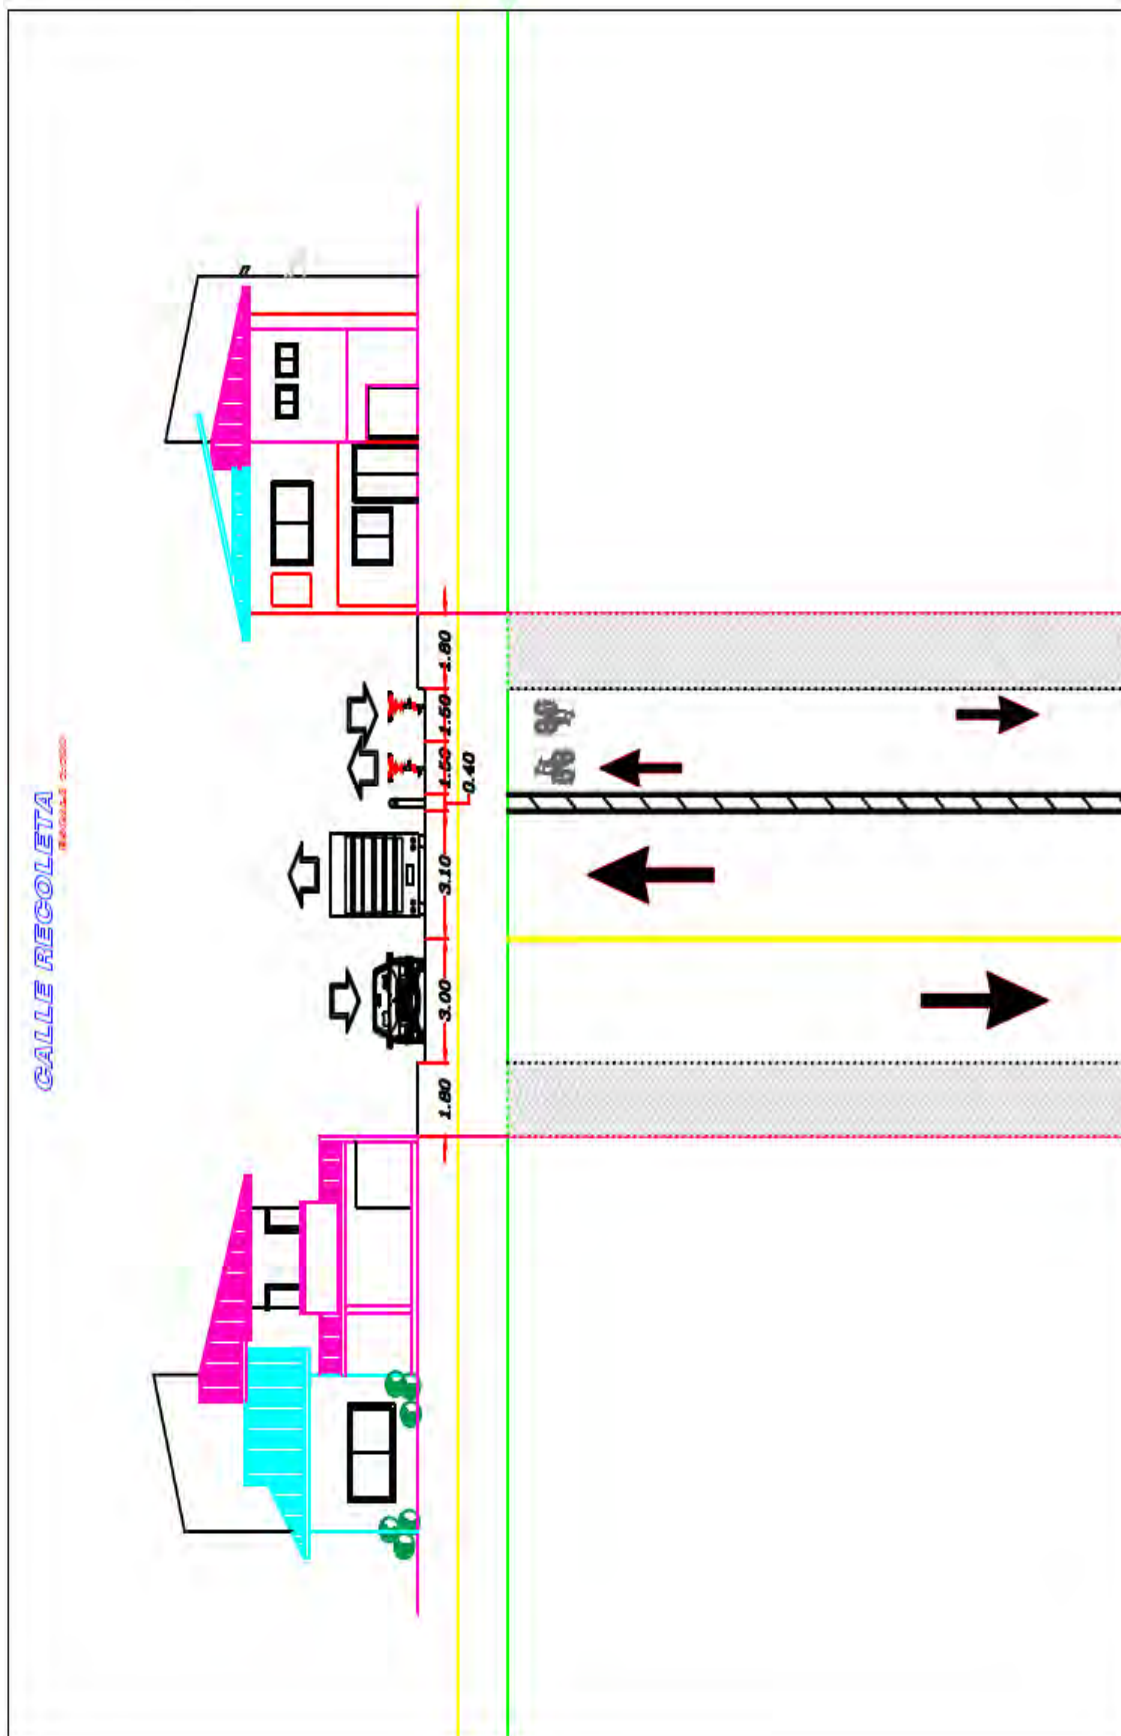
Propuesta Sección Transversal Calle Recoleta.
